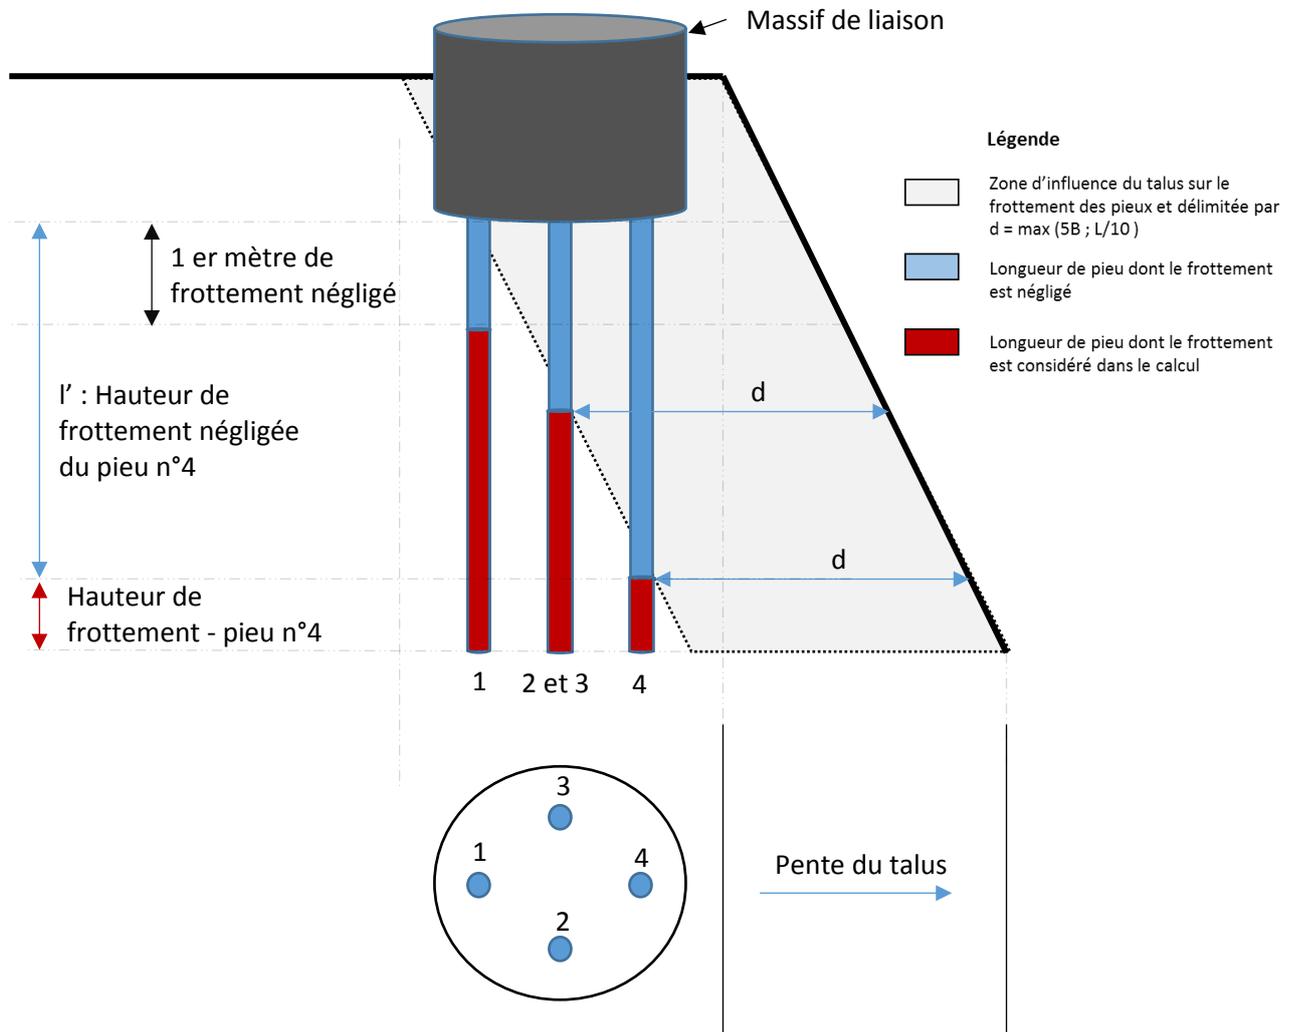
Fondation profonde multipieux établie à proximité d'un talus (vues plan et profil) – Influence du talus sur la prise en compte du frottement des pieux
